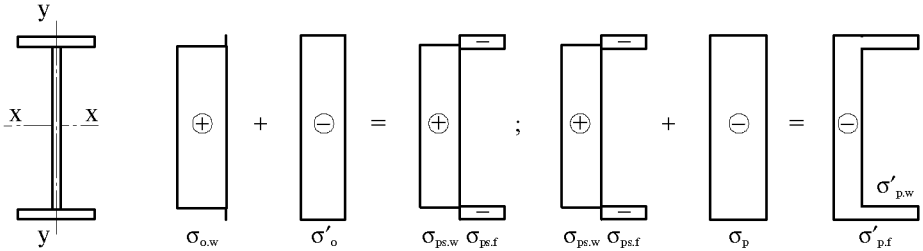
Эпюры нормальных напряжений в центрально сжатой тонкостенной колонне a – при натяжении стенки (напряжения сборки σ_0); b – после соединения стенки с поясами и передачи предварительного усилия на все сечение; σ – предварительные напряжения; ε – напряжения от сжатия стержня под внешней нагрузкой на систему; δ – суммарные напряжения
